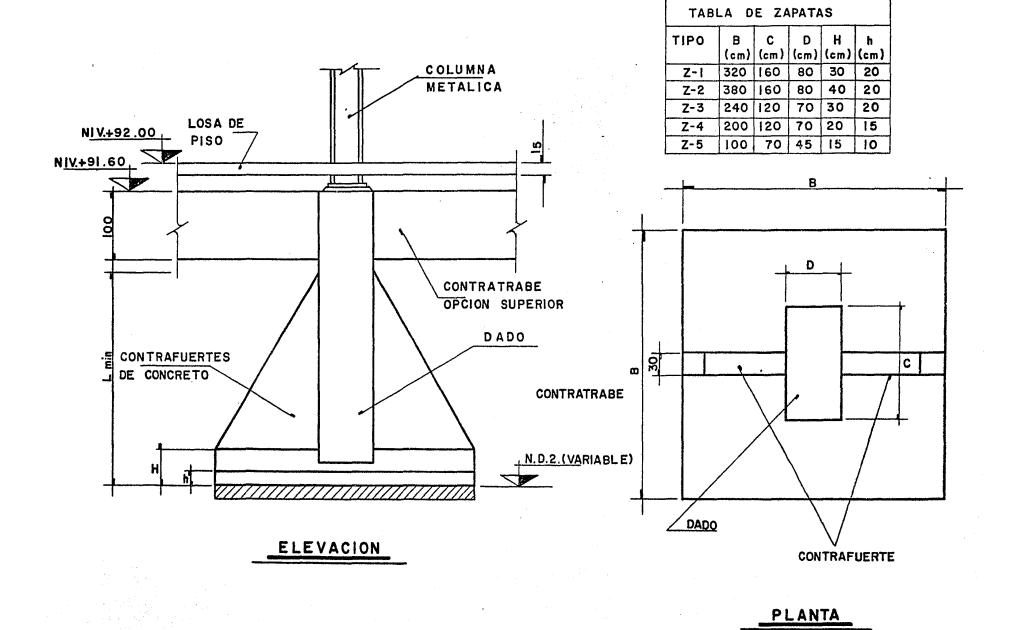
ZAPATA CARACTERISTICA TIPO!
